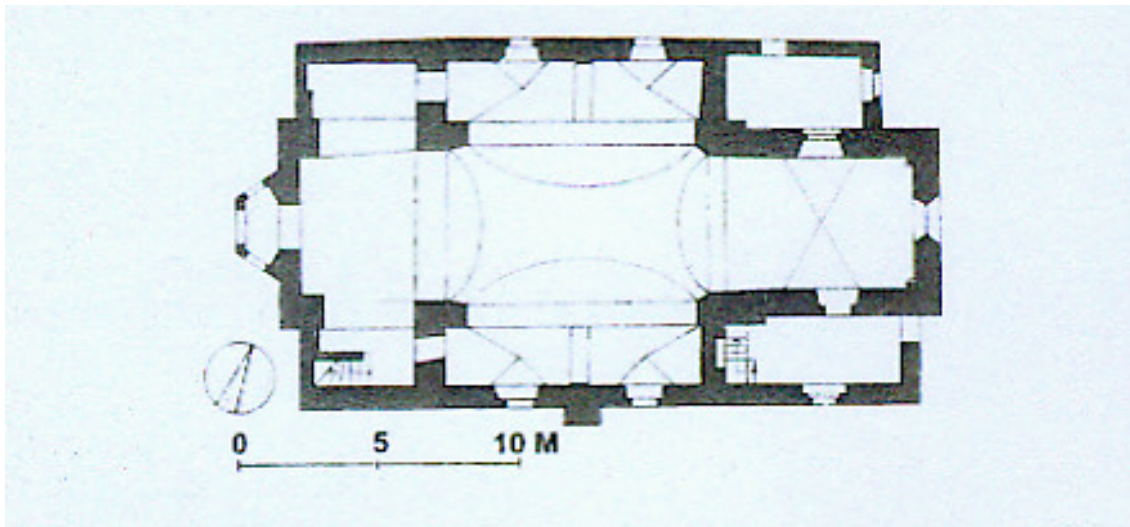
Grundriß, Pfarrkirche, Gaaden
